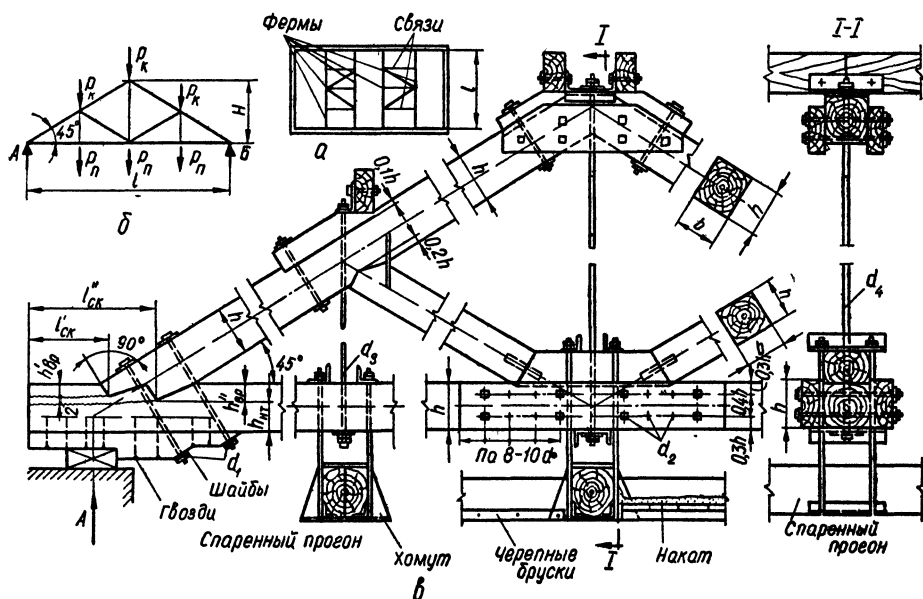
Конструкция треугольной фермы из брусев с тремя подвесками: а — расположение ферм и связей в плане; б — расчетная схема фермы; в — узлы фермы.
